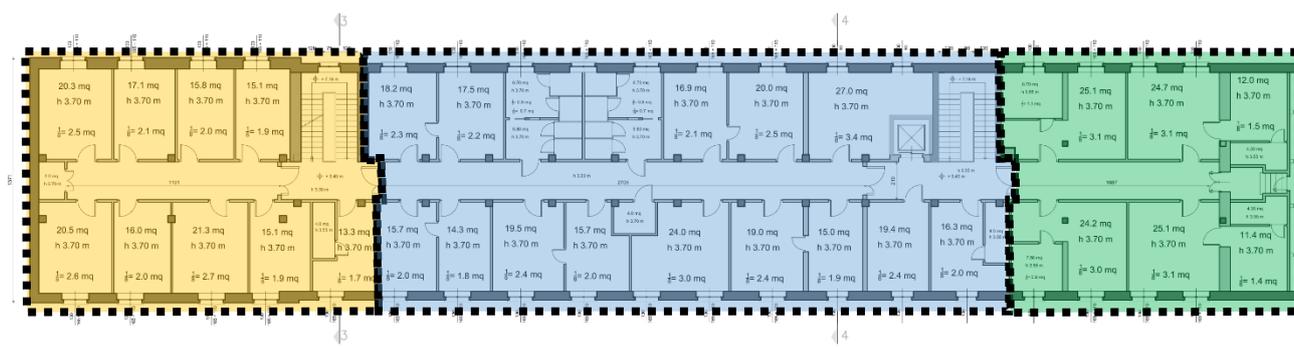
Schema distributivo piano delle camere – ipotesi progettuale
